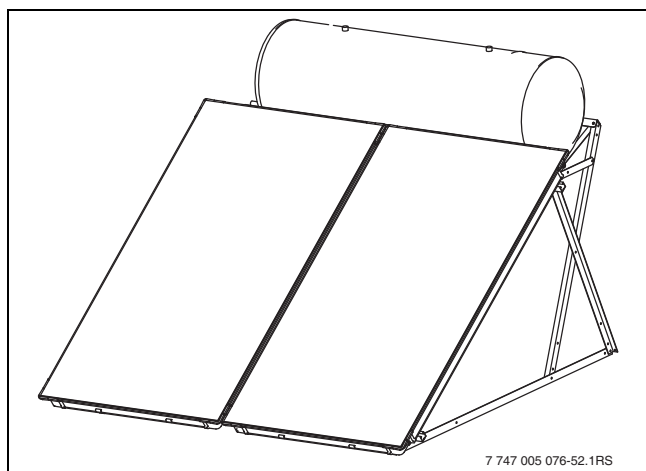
Vista montaje en cubierta plana (sistema de 300 l)
